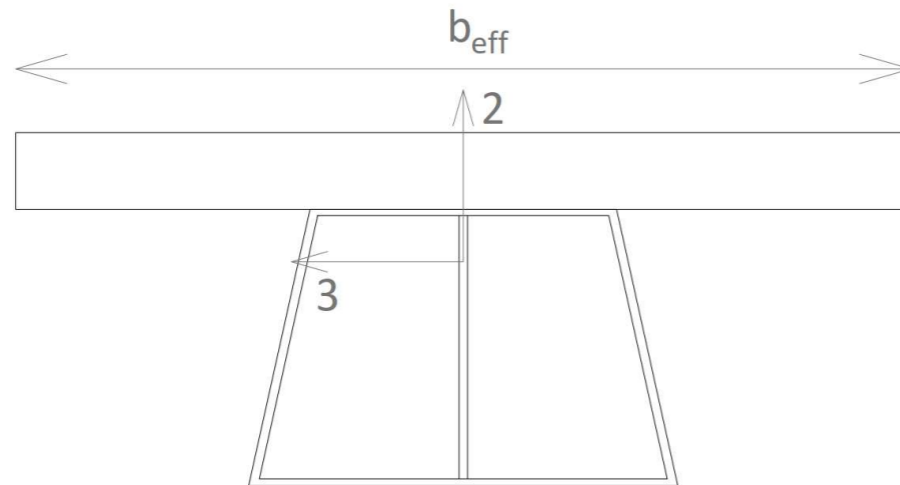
Ejes locales de las vigas longitudinales (fuente: elaboración propia)
